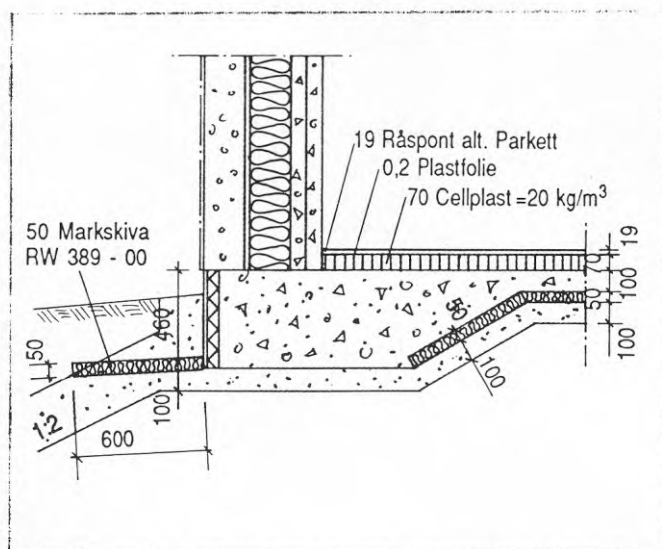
Anslutning mellan grund och gavelvägg i Sjuksköterskan. Gavelväggen i betong är klädd med 195 mm mineralullsisolering och med lättklinker med ytskikt av puts. Betongplattan saknar även här isolering under kantbalken.
